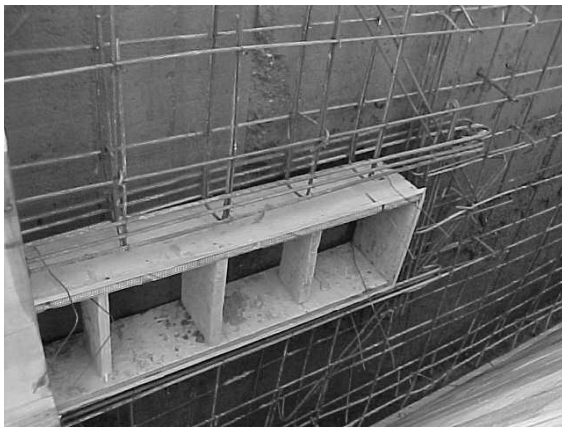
Control posicionamiento estructuras metálicas y de las platinas de anclaje.
